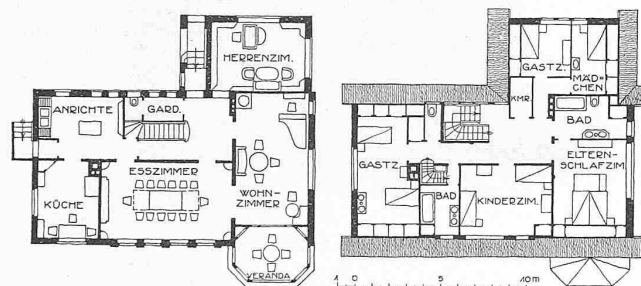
u. 13. Haus Plesch bei Hamburg. Grundrisse 1:400.
